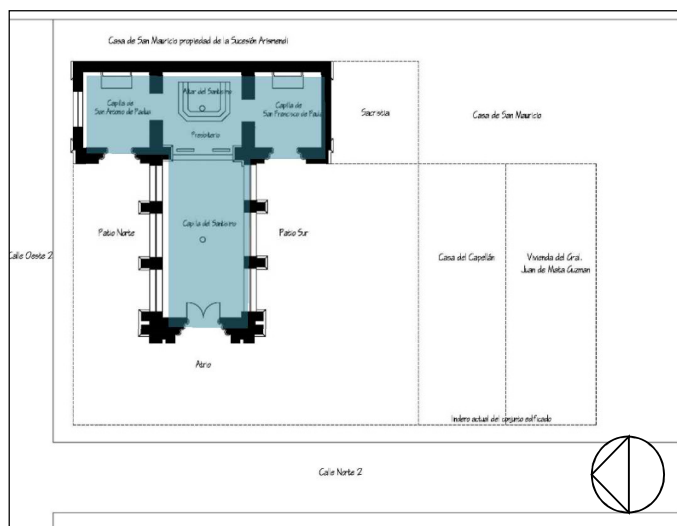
Planta hipotética Primera etapa de Santa Capilla. (Pérez, 2011)
